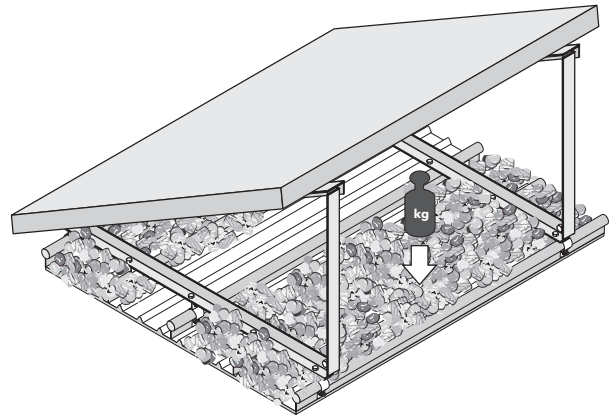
Beschwerung der Stehfalzplatte mit Kies
